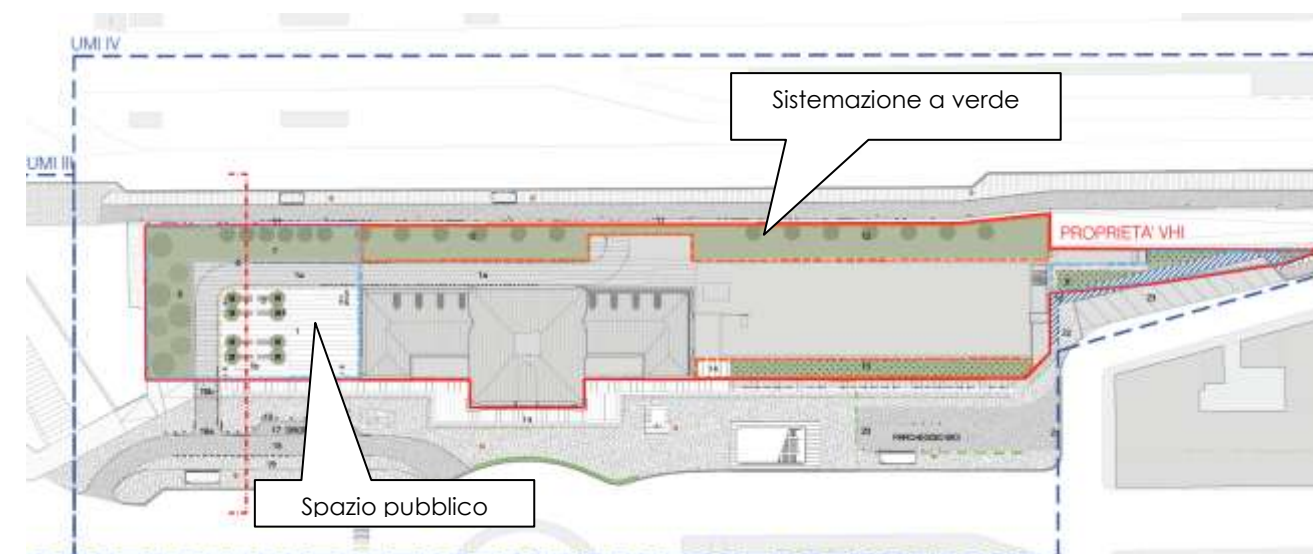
Planimetria di progetto - aree verdi e spazi pubblici
